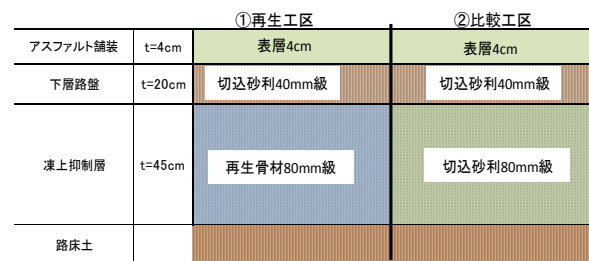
試験施工箇所 (旭川市東鷹栖) 施工時期 H21.8
